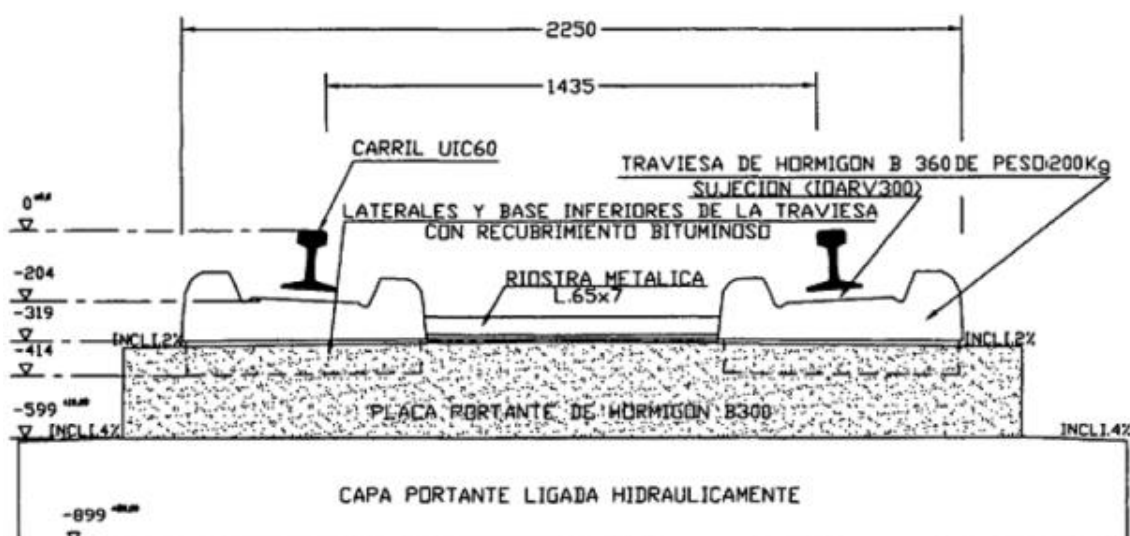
Perfil transversal esquemático da solução Züblin (Escolano Paul, 1998)
